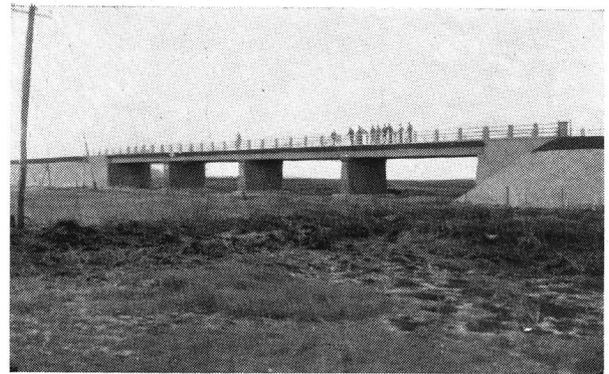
Tipo de puente de hormigón, con barras soldadas eléctricamente
